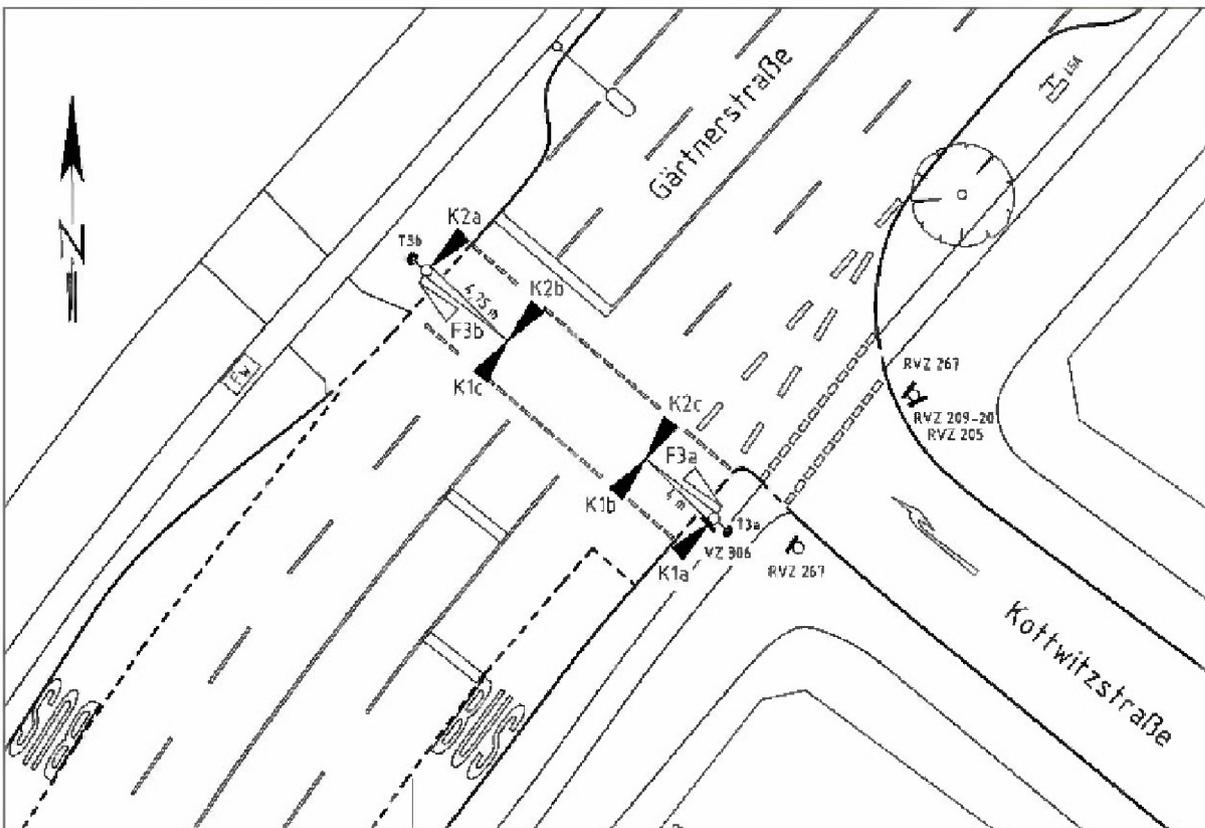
2 Signallageplanausschnitt LSA 1046
